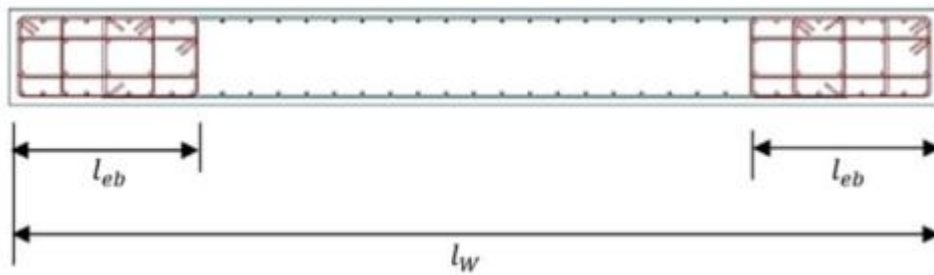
Longitud de elemento de borde para los sistemas de muro estructural
